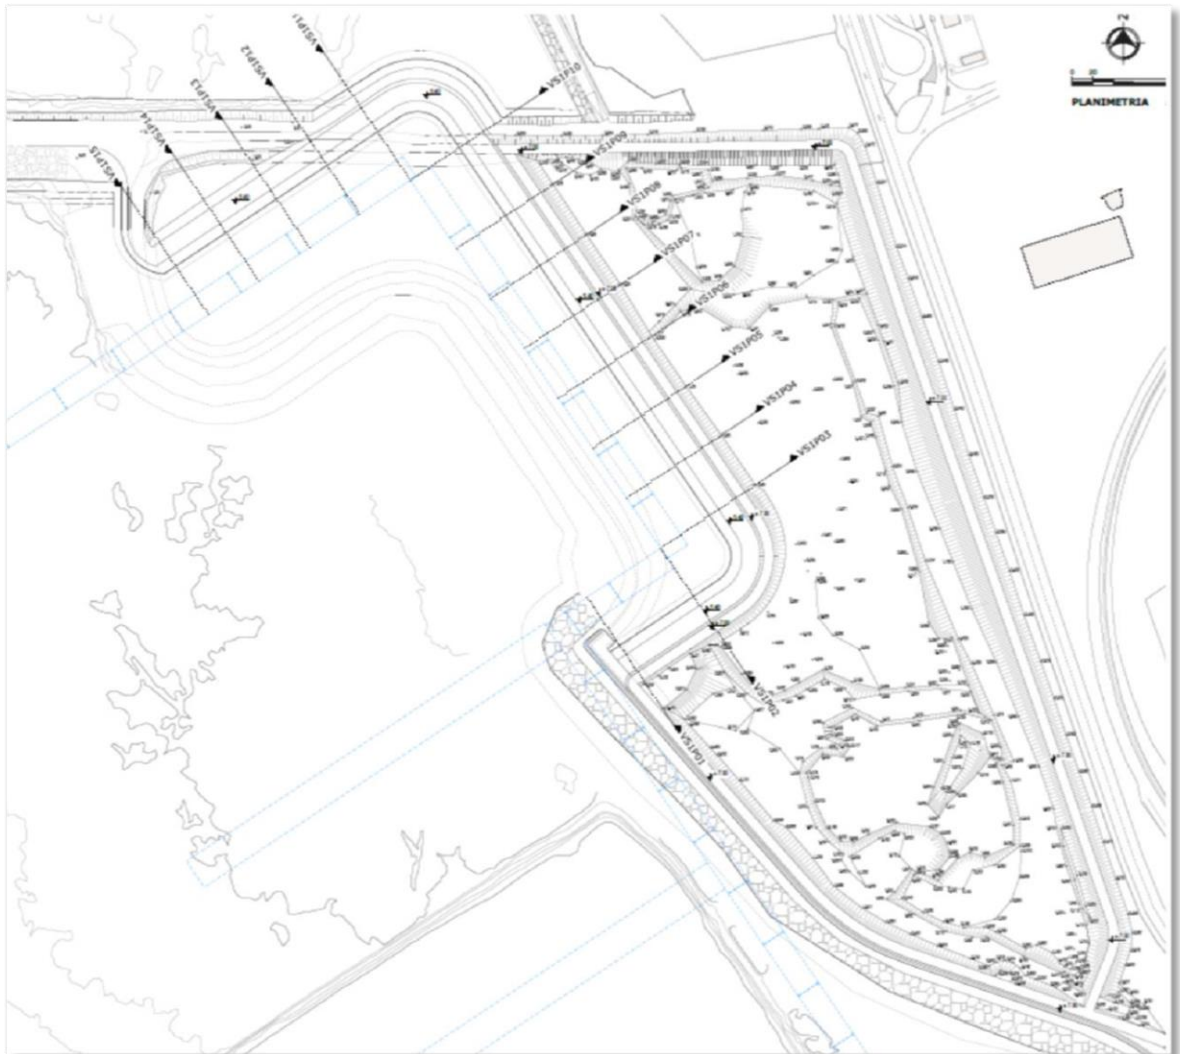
Planimetria delle sistemazioni in zona Mattonara
